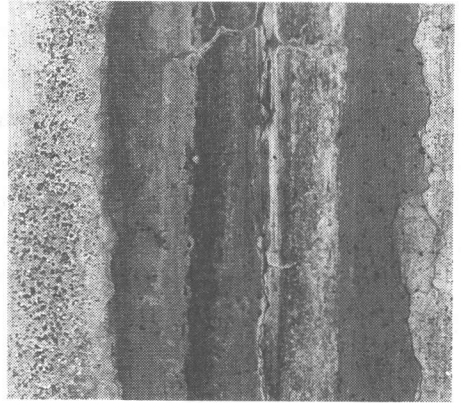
コンクリート表面の劣化状況 (P 6 橋脚, A 側面)
